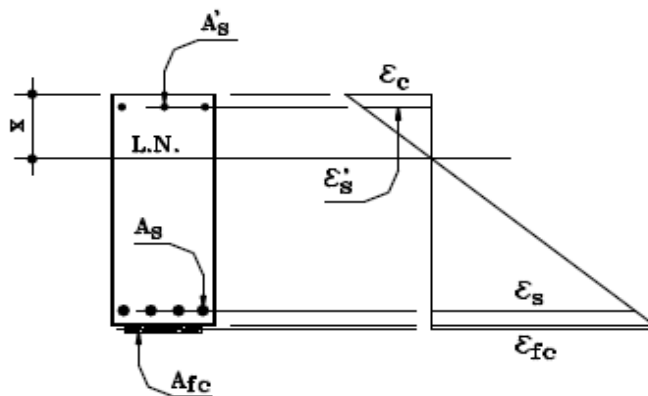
Deformações na seção transversal de uma viga em concreto armado
